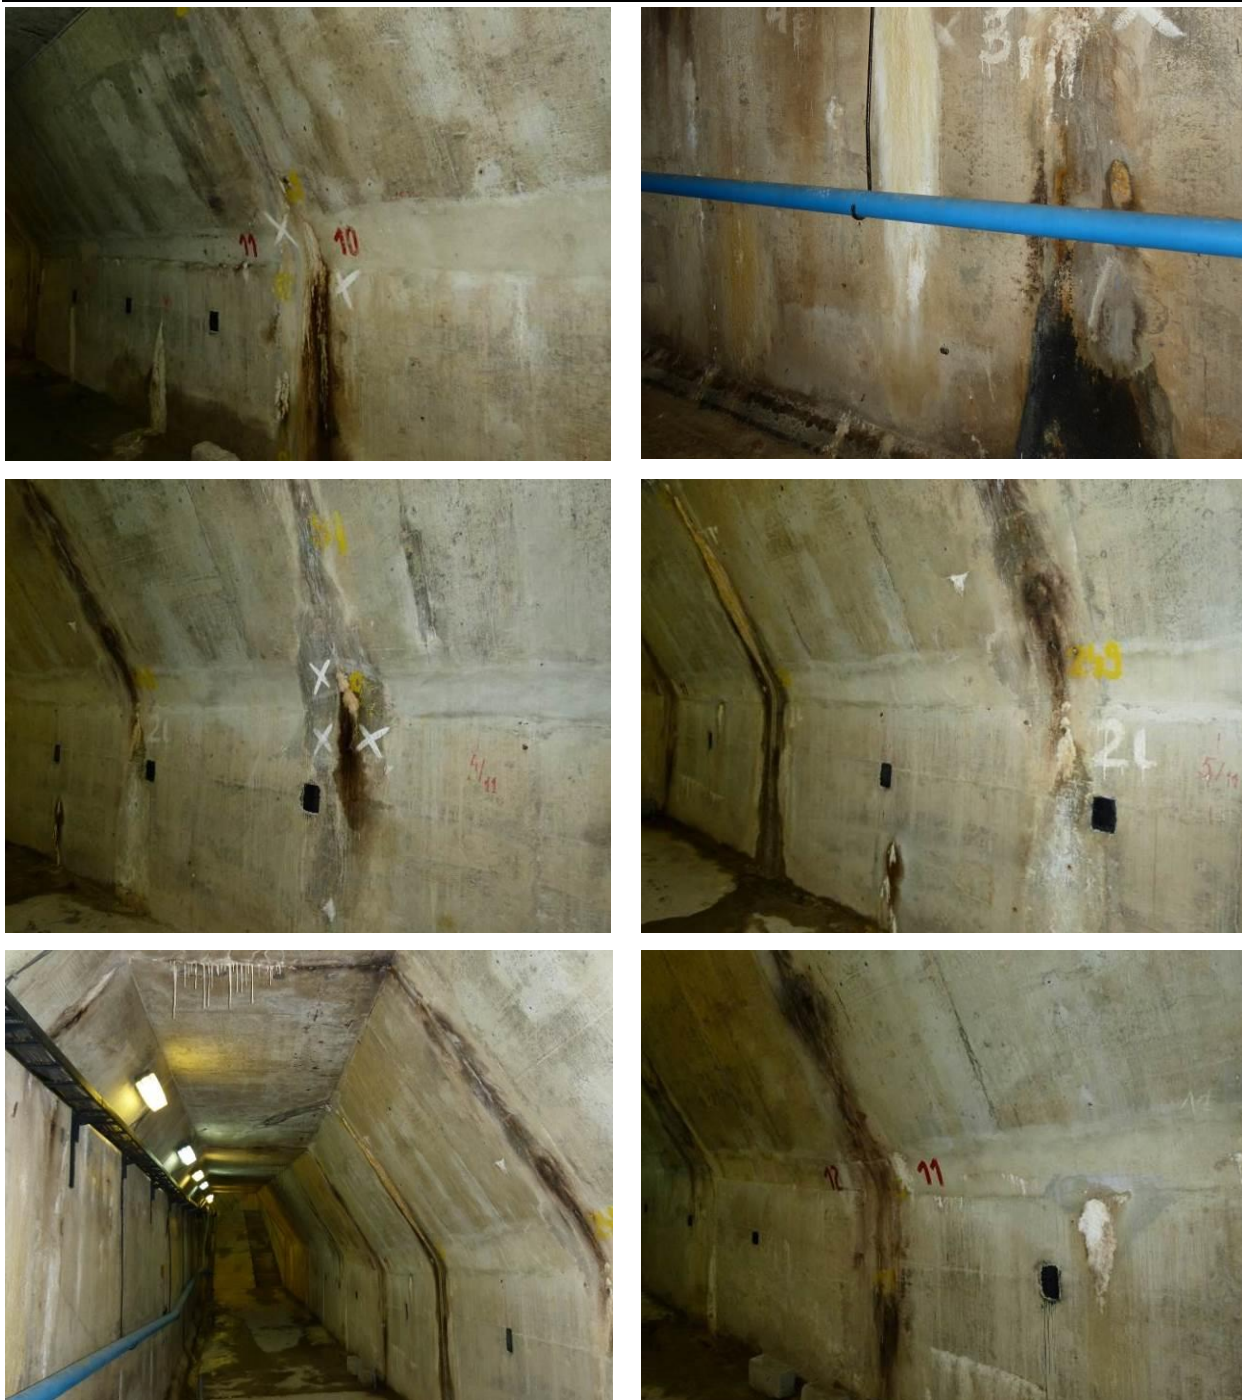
Widok na stan techniczny sekcji nr 9 konstrukcji galerii kontrolno-zastrzykowej
